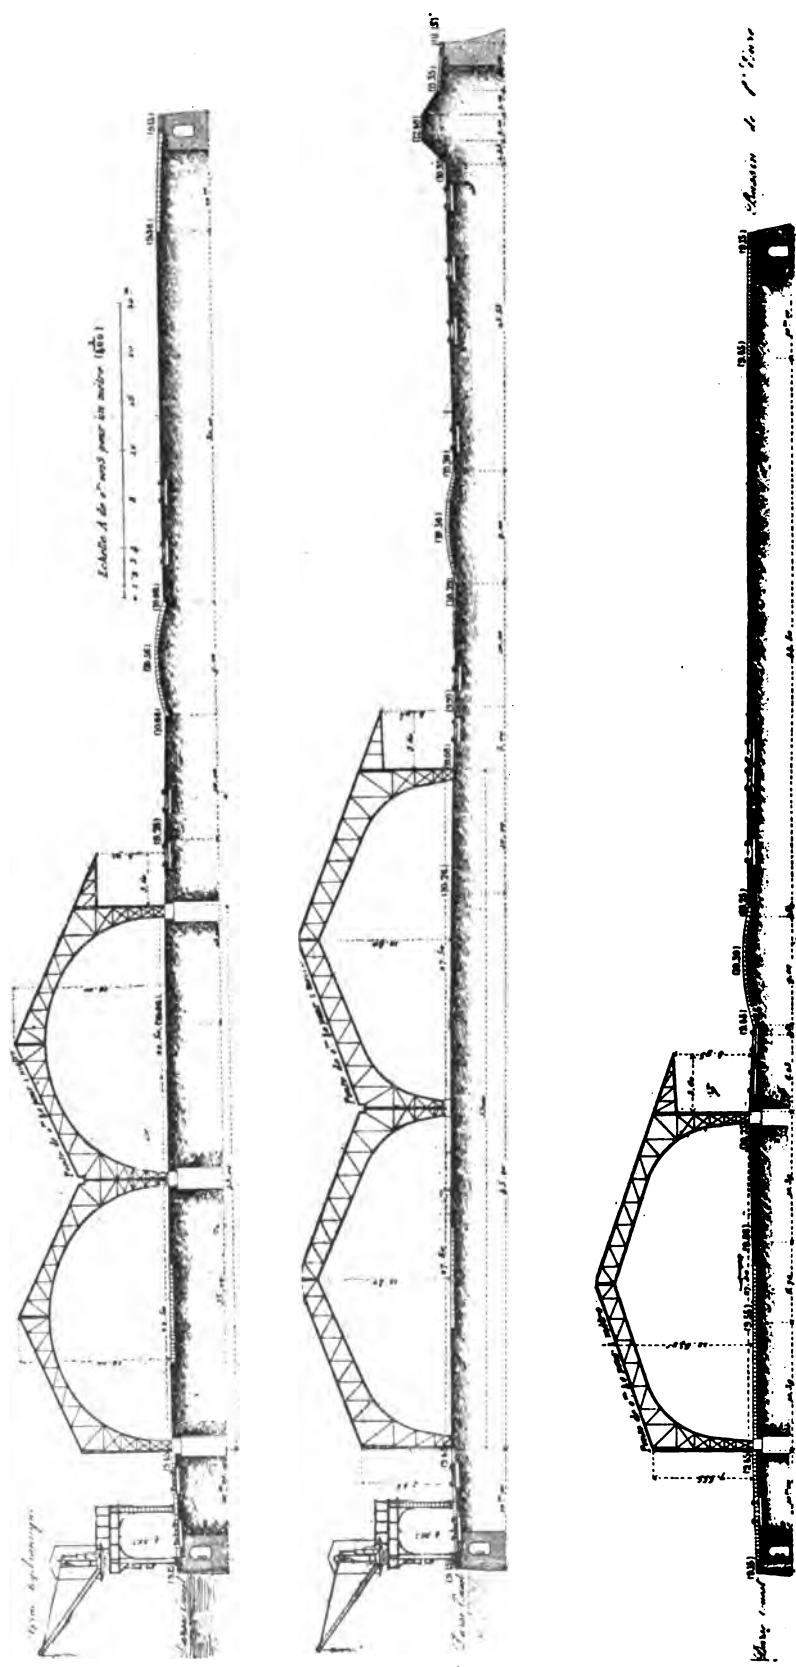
Hangars du bassin Bellot. — Coupe diverses.
